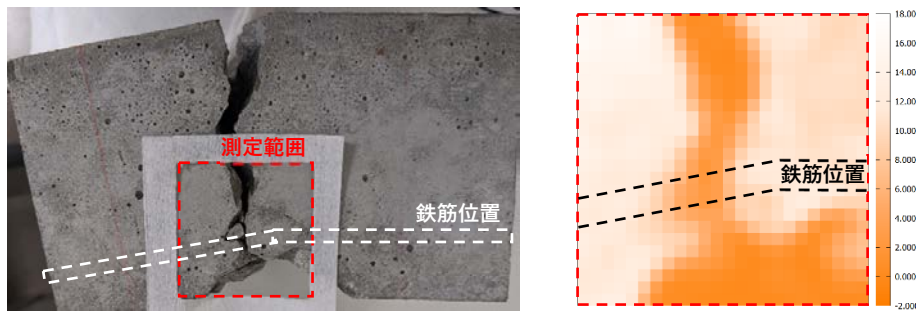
鉄筋コンクリート試験体・ひび割れ部分
